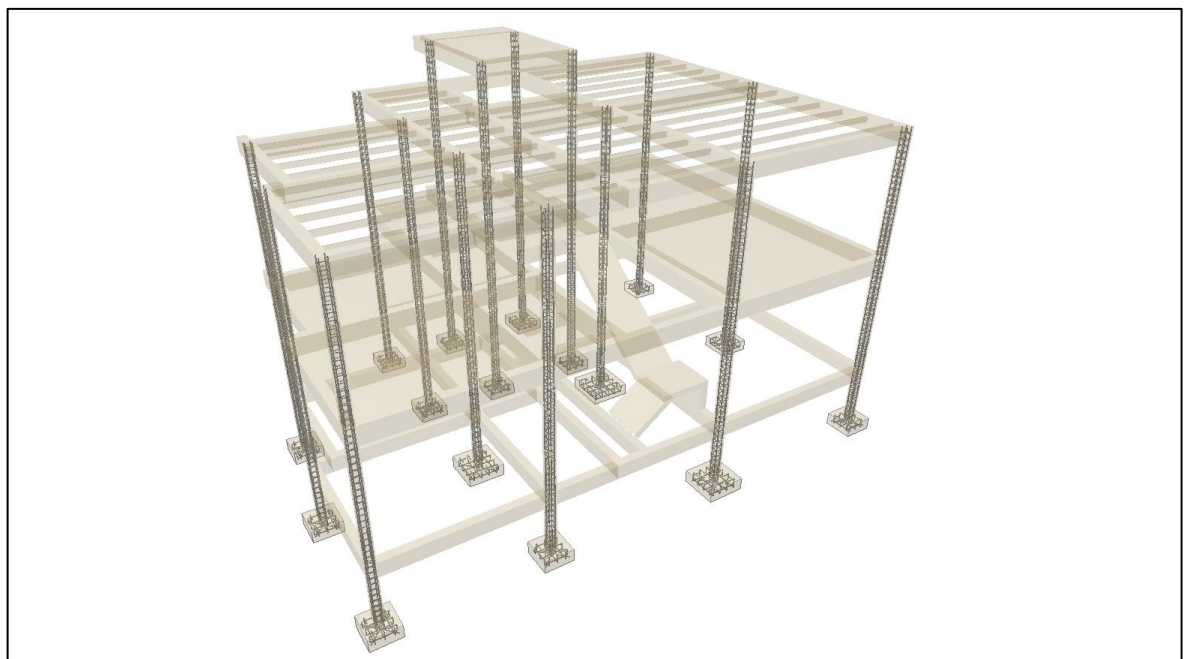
Esquema de estructura – Estructura completa con fundacion.
